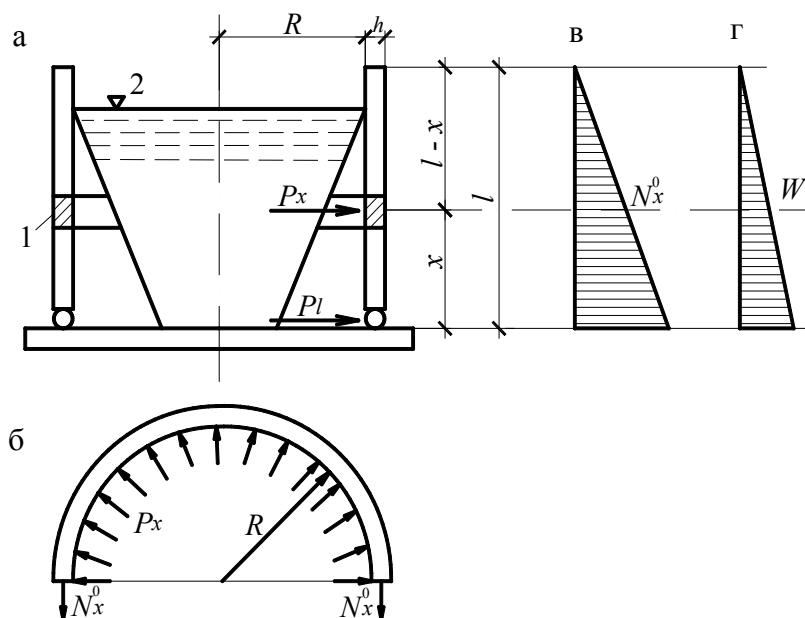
Расчетная схема цилиндрического резервуара:
